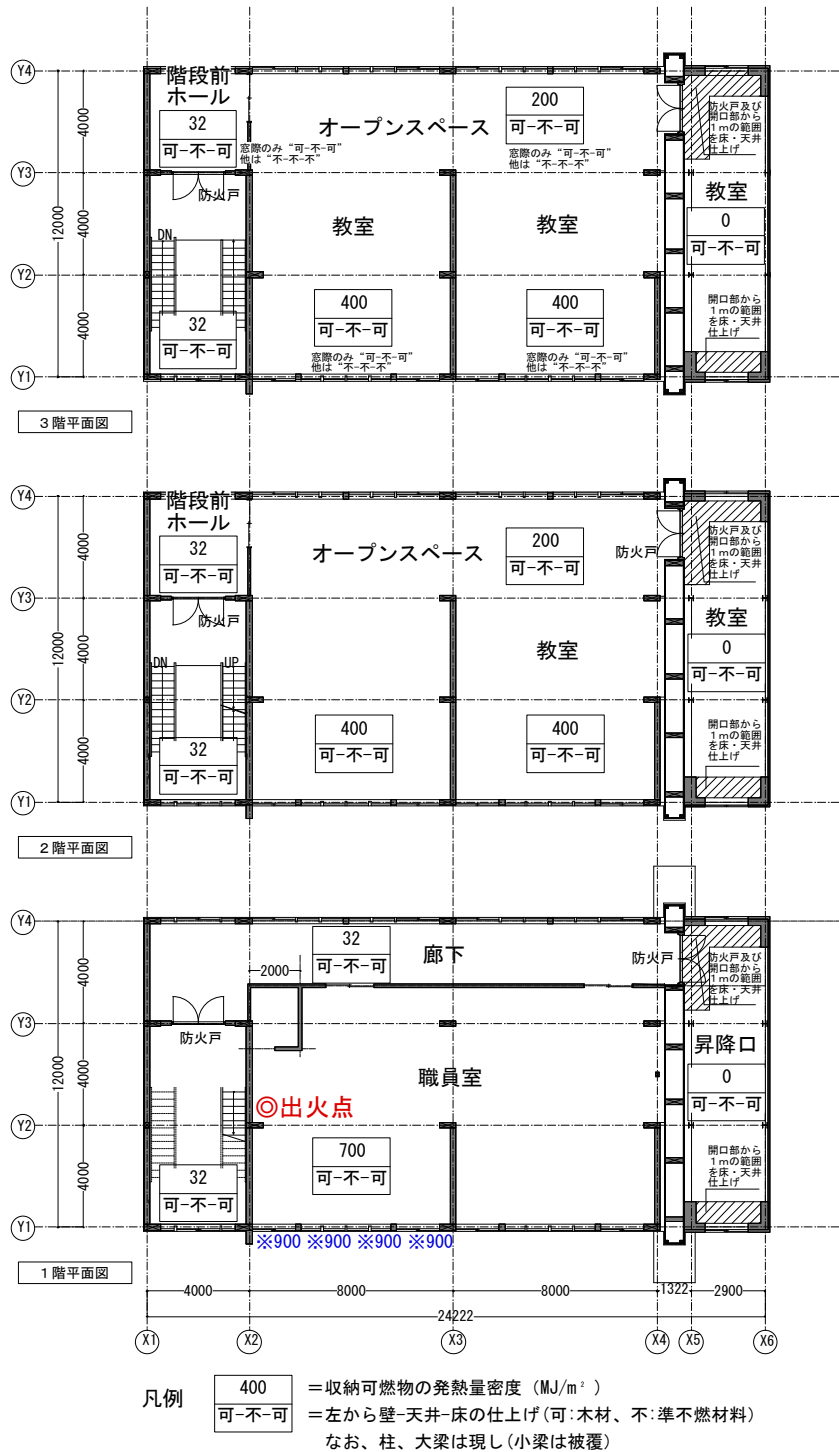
平面図および開口・収納可燃物等条件 (本実験)
